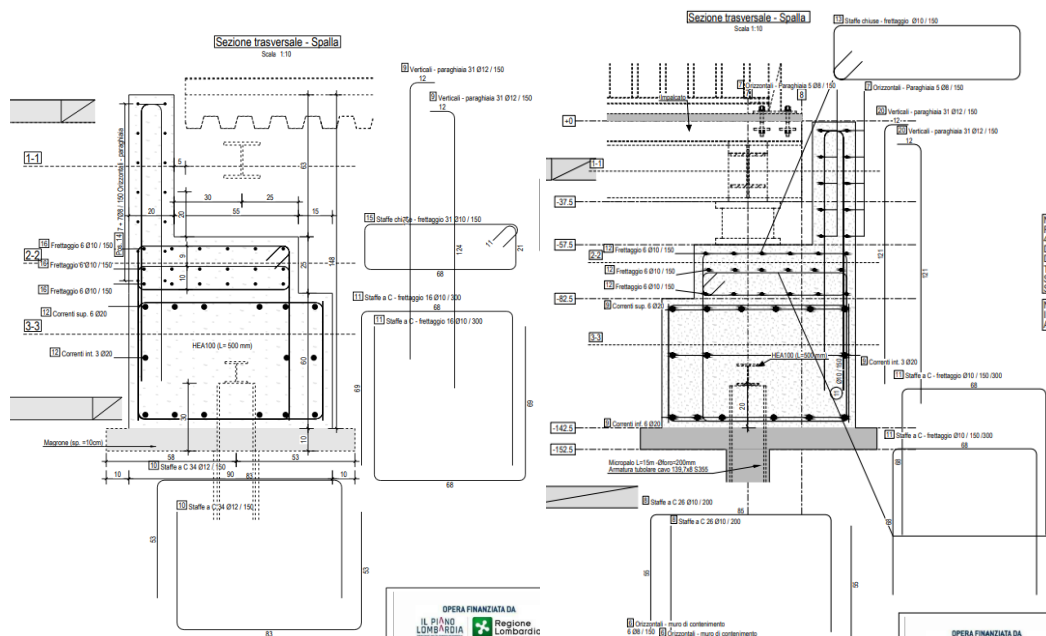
Sezioni Spalle di fondazione: a sx "2B" e DX "1C e 1D" – armatura
